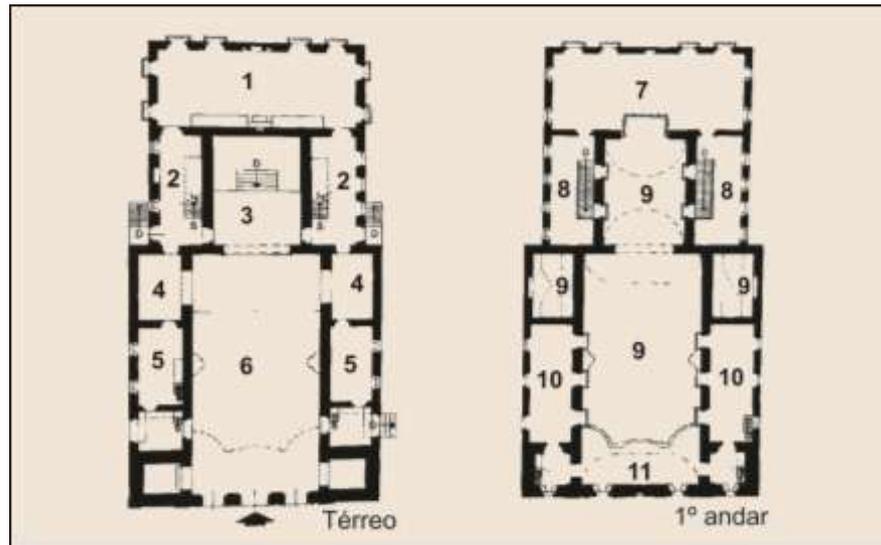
Planta baixa Igreja Matriz de Cachoeira
